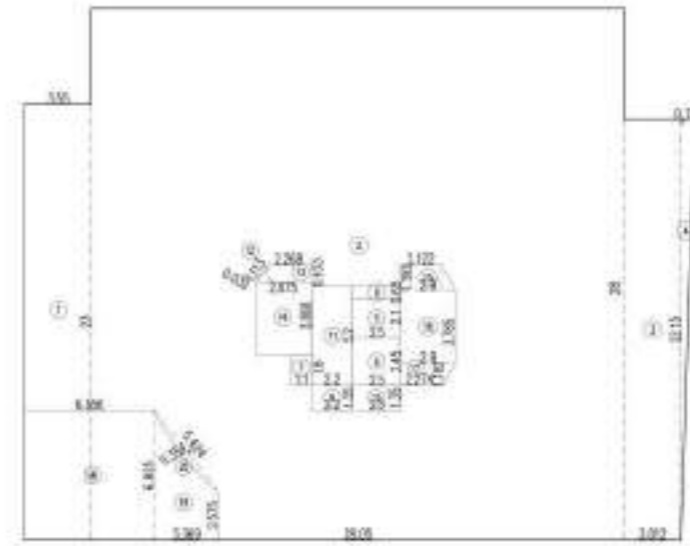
地下 1 層平面圖 (比例尺 1/200)
